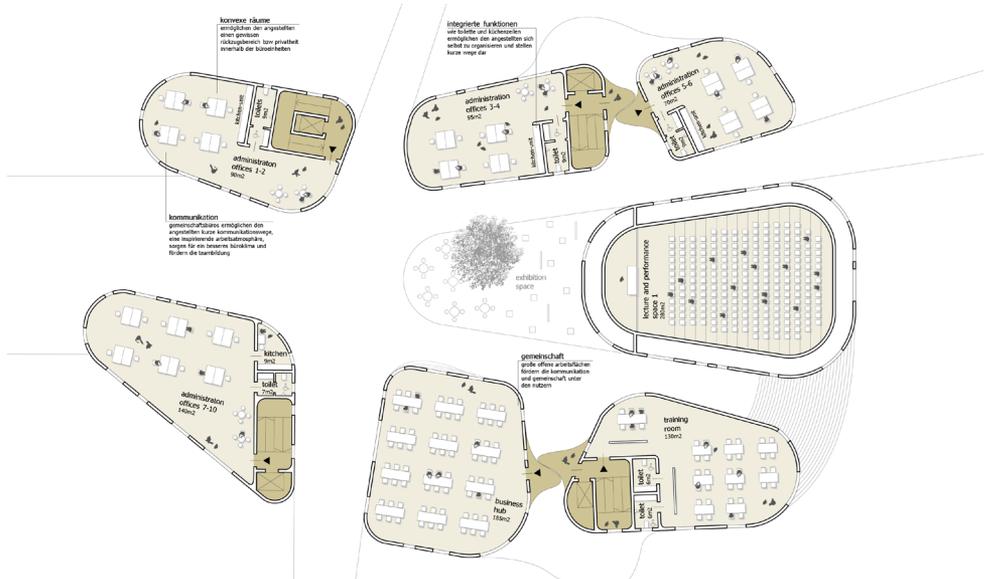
Grundriss 1. Obergeschoss
